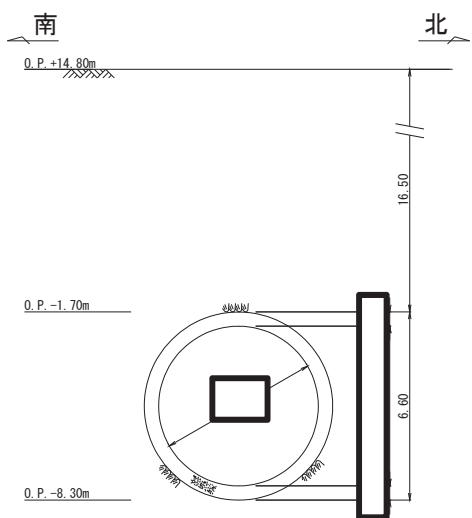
排気筒連絡ダクト断面図（岩盤部, B-B）
